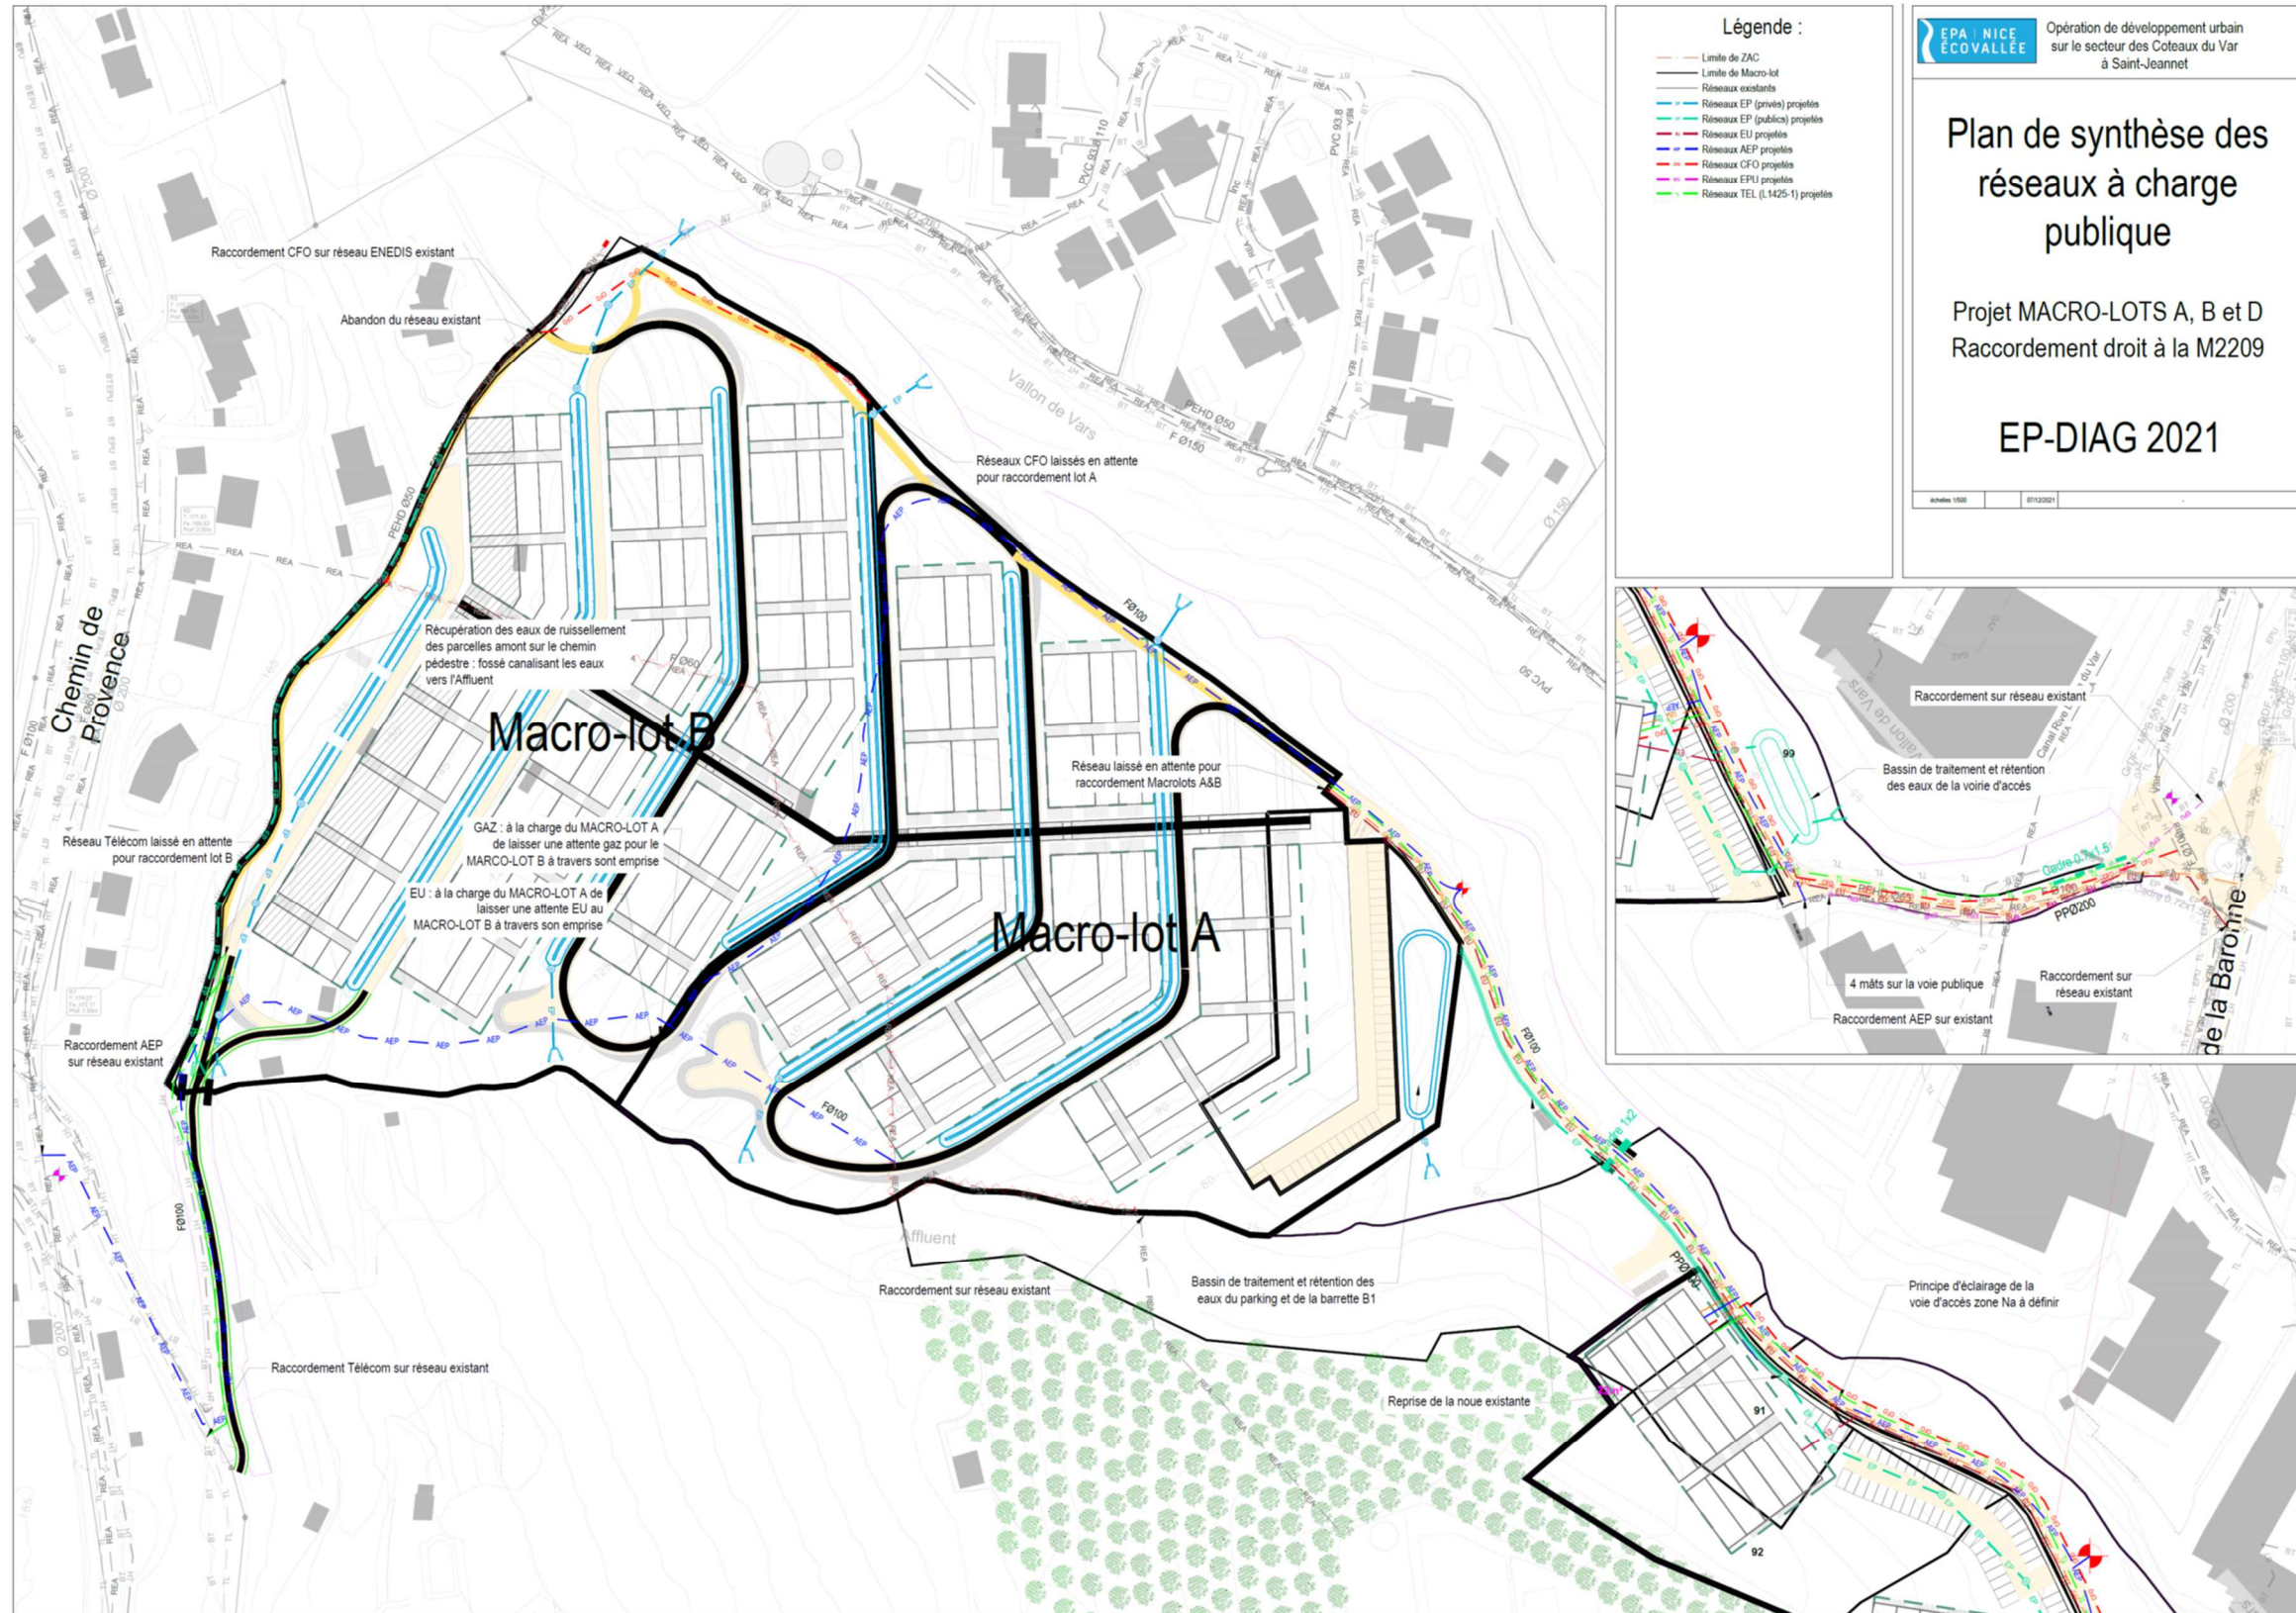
Plans prévisionnel des réseaux au stade des études actuelles
